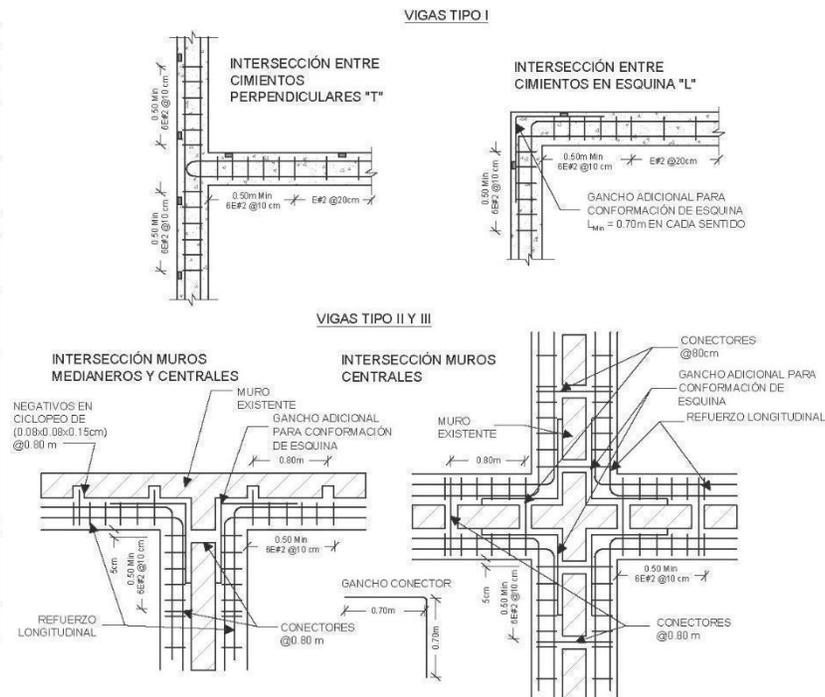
Nueva viga de cimentación en concreto reforzado para muros perimetrales sobre concreto ciclópeo existente.
